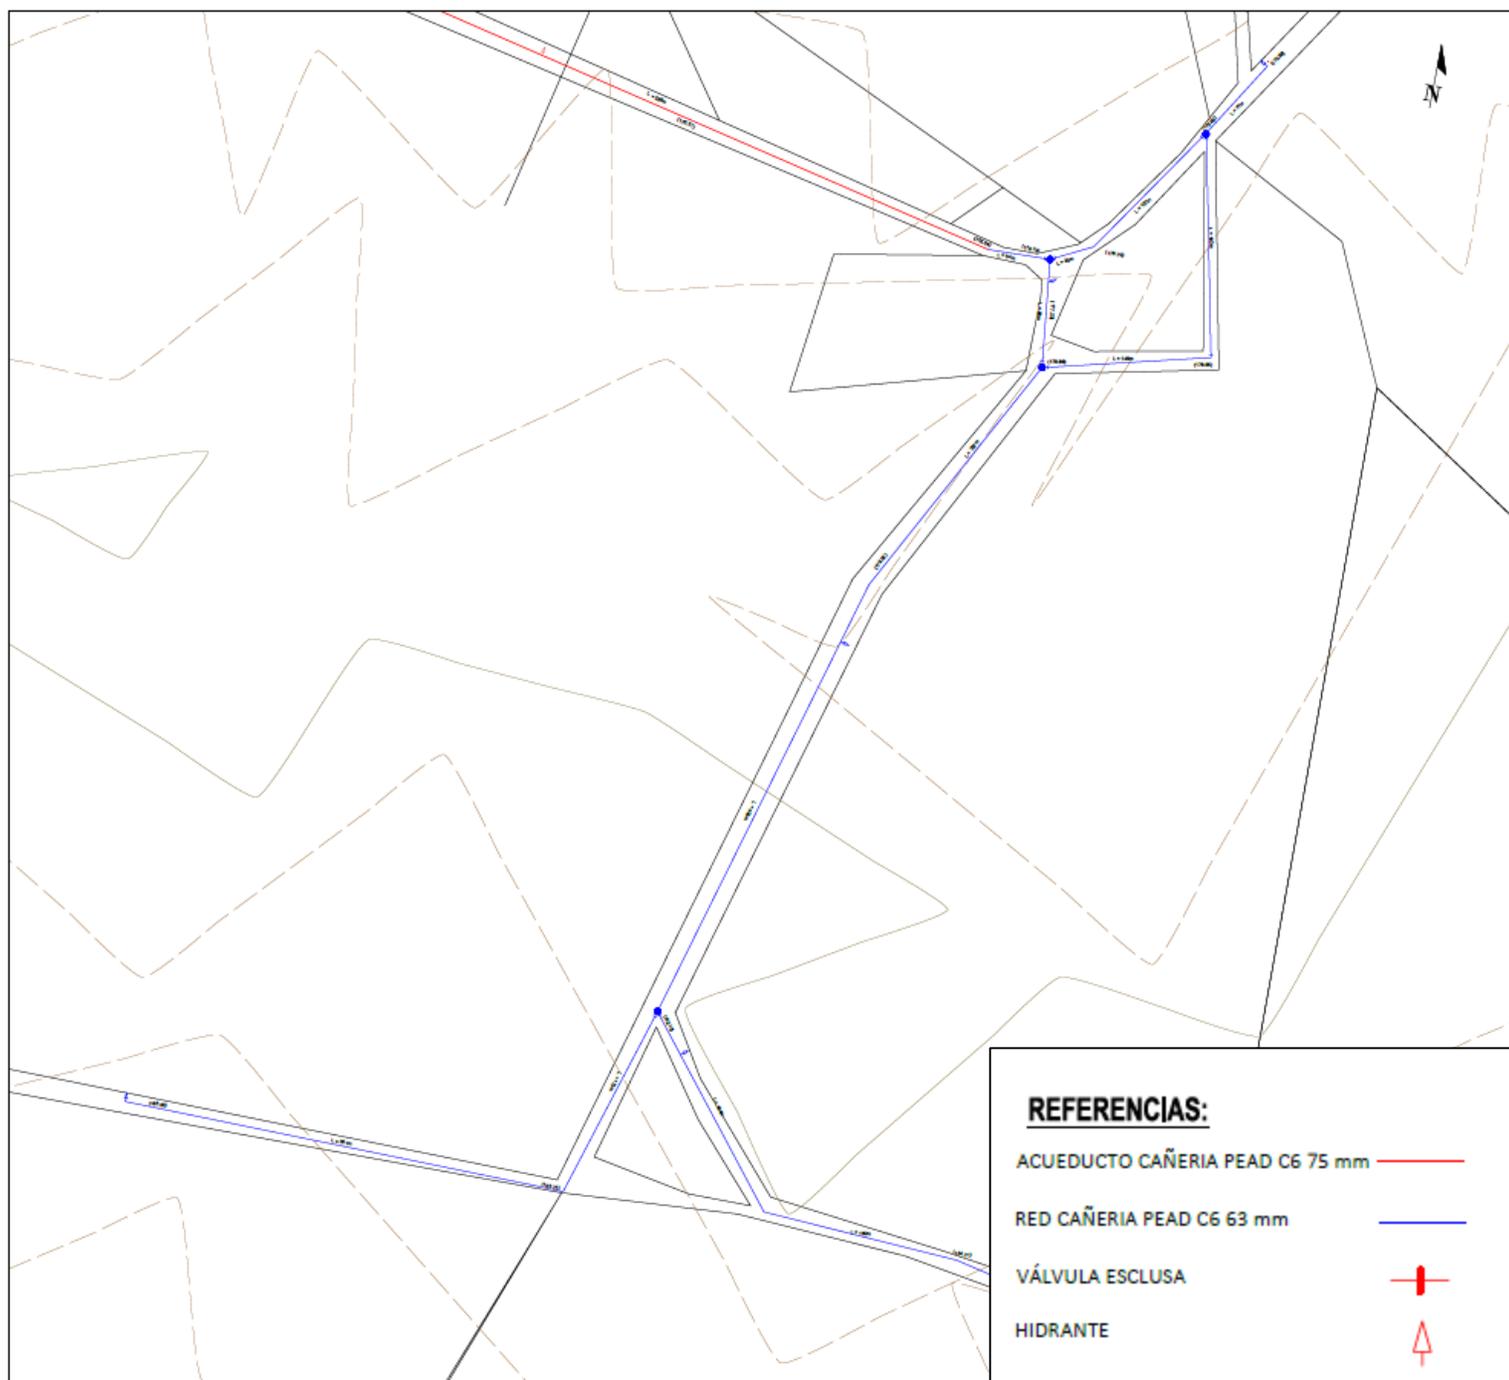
Planimetría de la obra en la Localidad de El Tuscal
